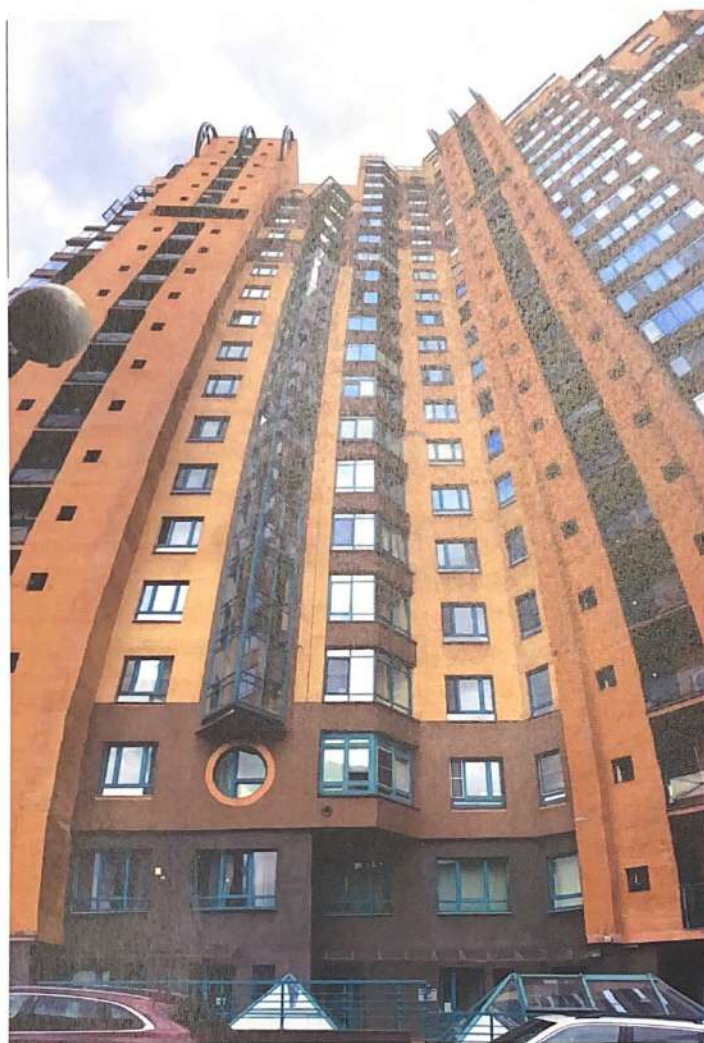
Секции 11-12. По исполнительной схеме Фасад 2.
